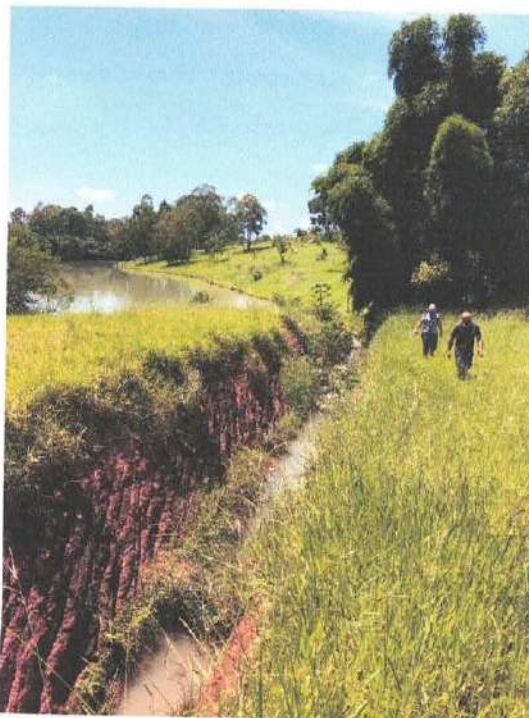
Vista de jusante para montante da "vala" escavada;
